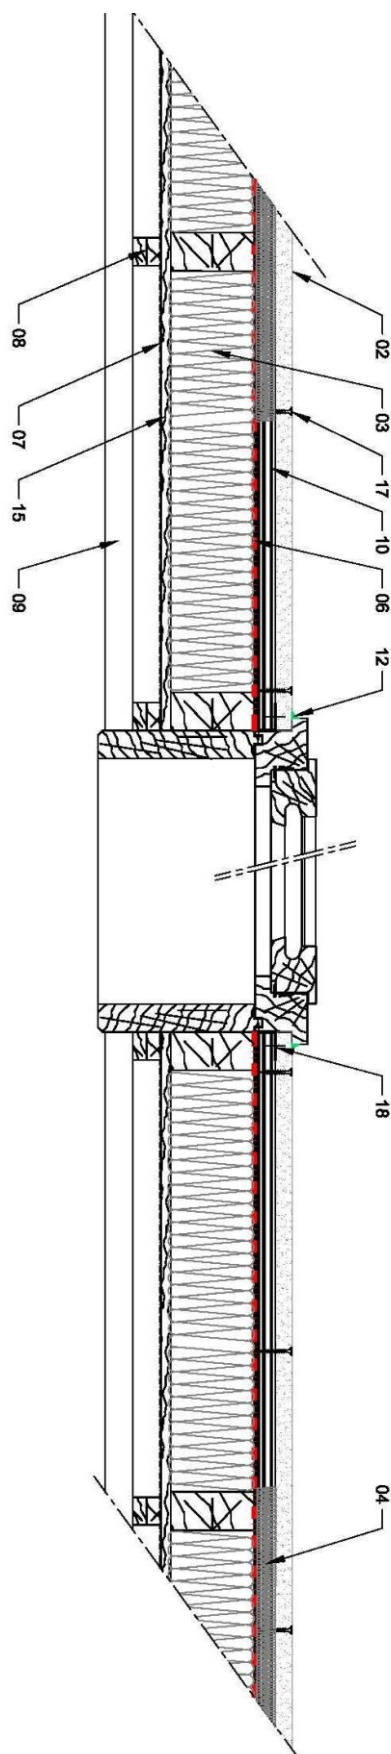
Jonction avec menuiserie - Coupe horizontale sur façade à ossature bois
